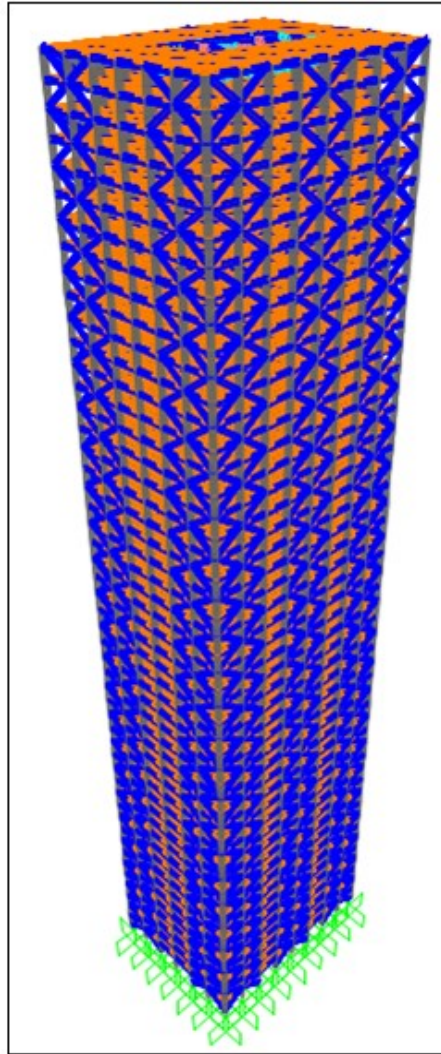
Betonarme yapı 3 boyutlu modeli
